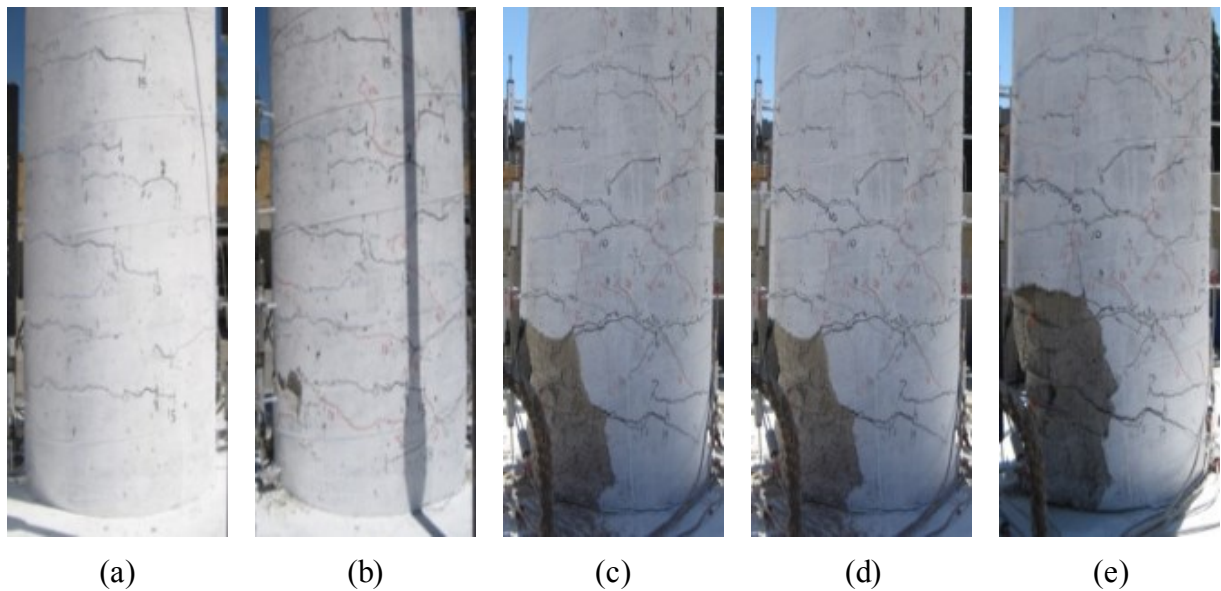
Estágio de análise do pilar moldado no local com armadura unida por luvas. (a) aparição das primeiras fissuras, (b) desenvolvimento de fissuras por cisalhamento, (c) extensão das fissuras e quebra do concreto, (d) reforço transversal e/ou transversal torna-se visível e (e) conjunto de danos e falha iminente da estrutura.
